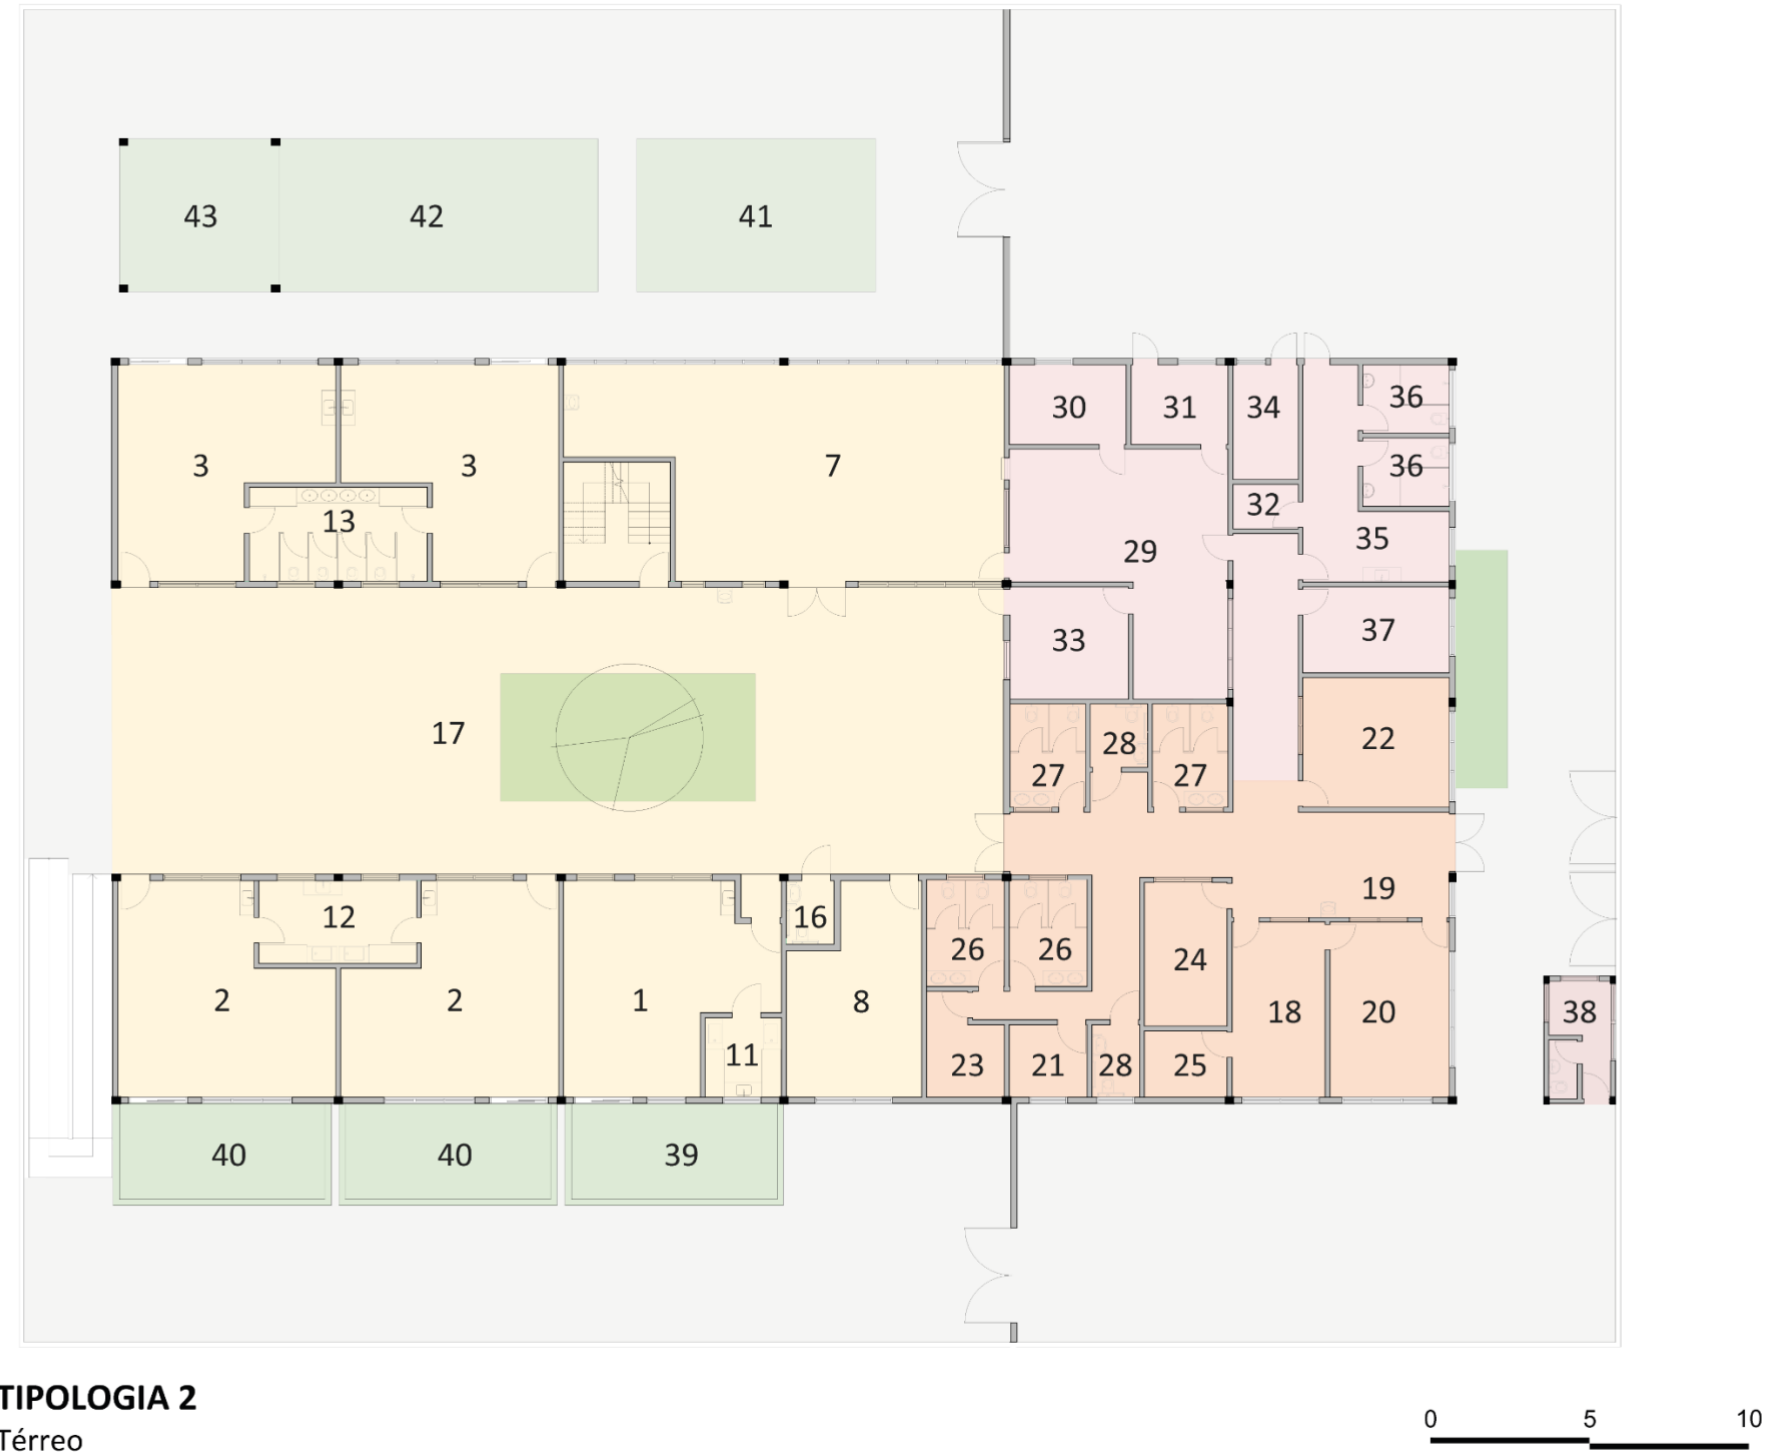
Planta Referencial Tipologia 2 –1º Pavimento
